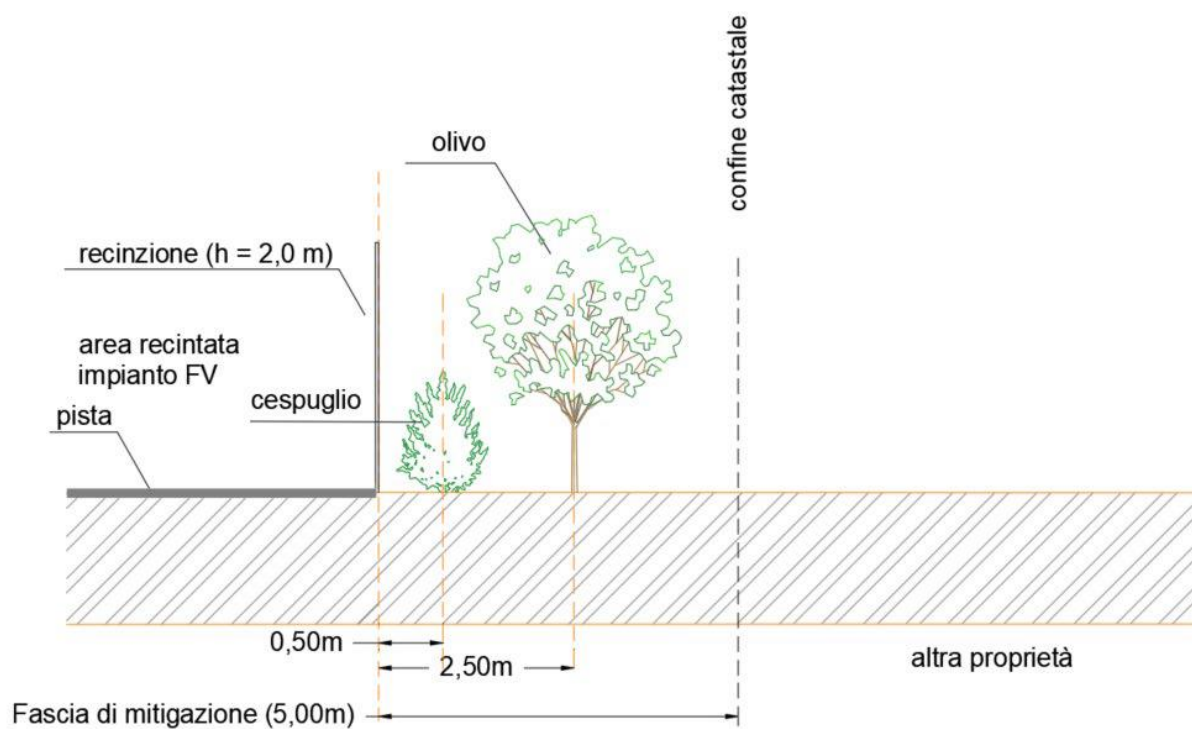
Stralcio di sezione dell'area perimetrale dell'impianto – siepe e filare di olivo.
